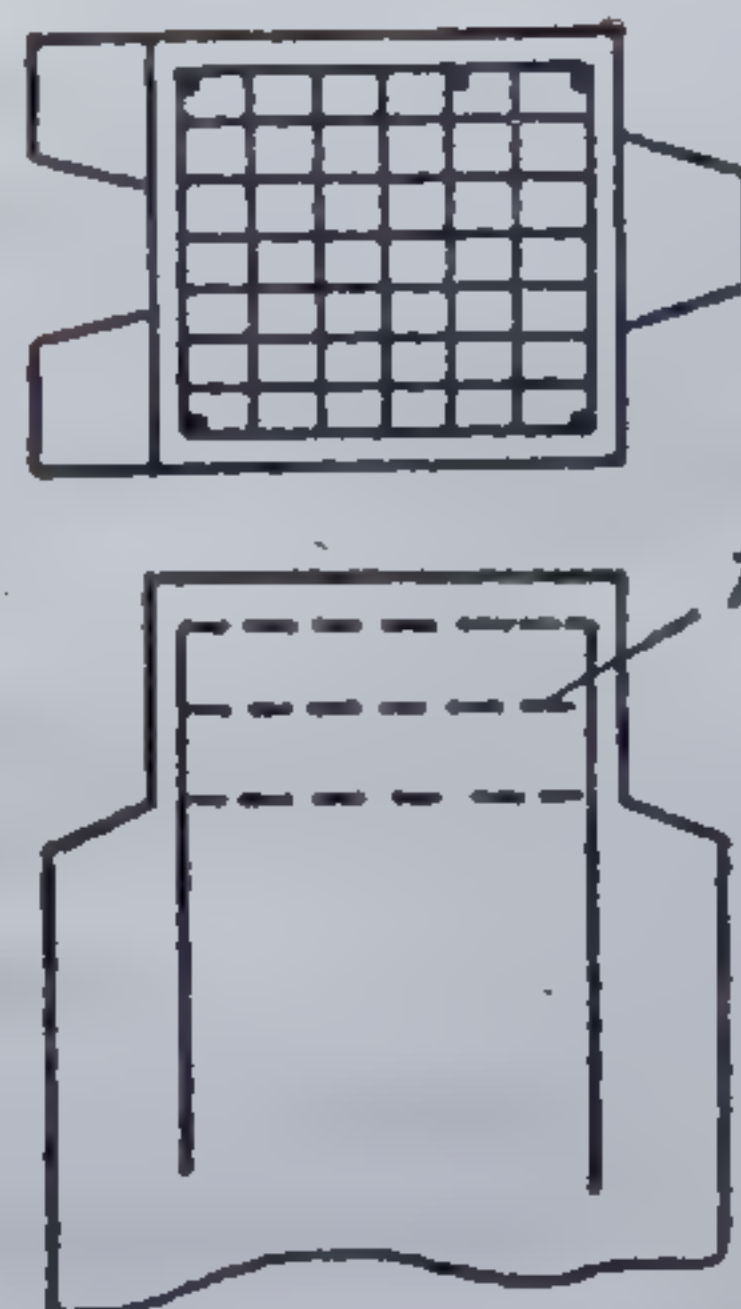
Detaliu de capăt al palplanșei din beton armat:
